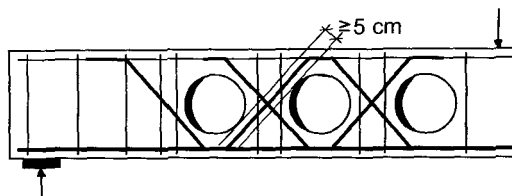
Bewehrungsanordnung bei Balken mit runden Aussparungen [84]
